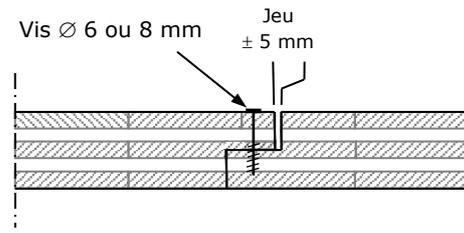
Assemblage par interposition d'une bande de liaison (joint languette)
